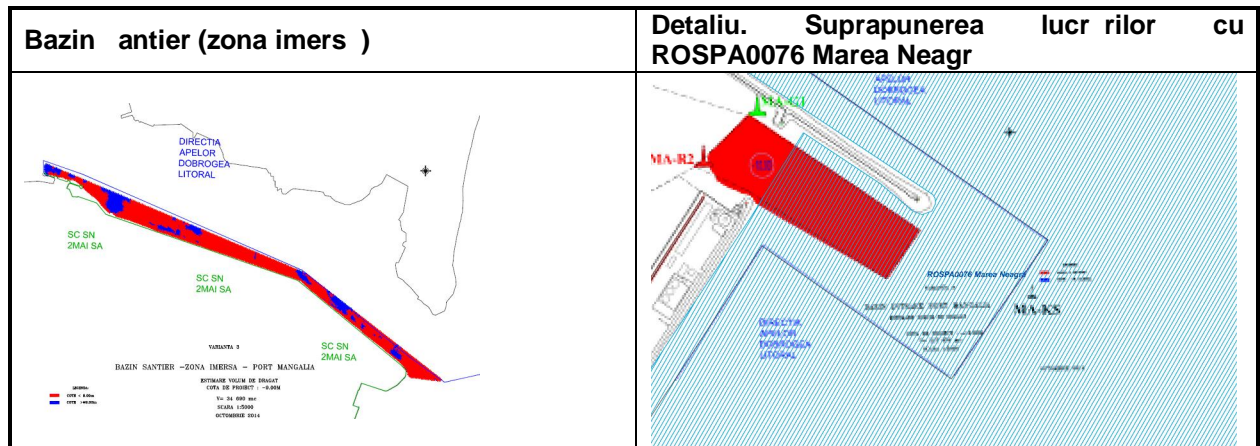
Plan de dragaj portul Mangalia.
